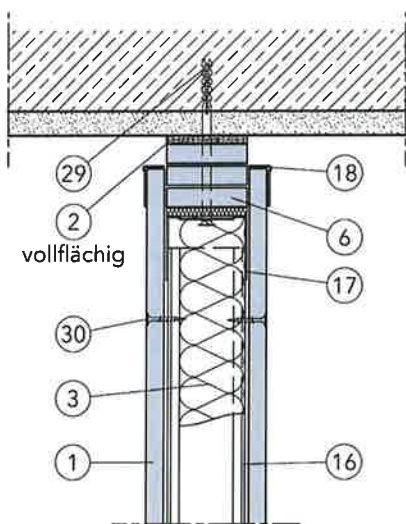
Starrer Deckenanschluss an Massivdecke mit einlagiger und zweilagiger Bekleidung
